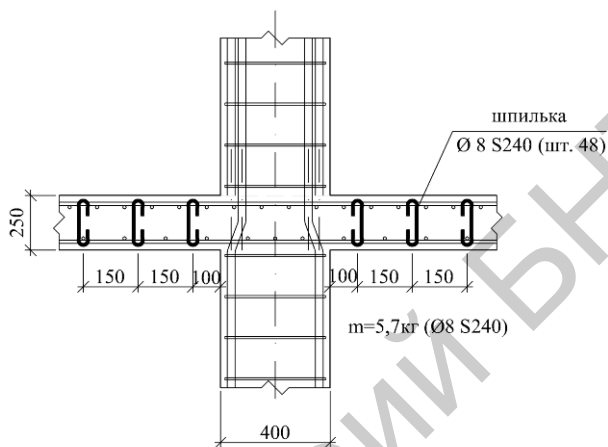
Схема поперечного армирования зоны продавливания плиты стержневой арматурой
